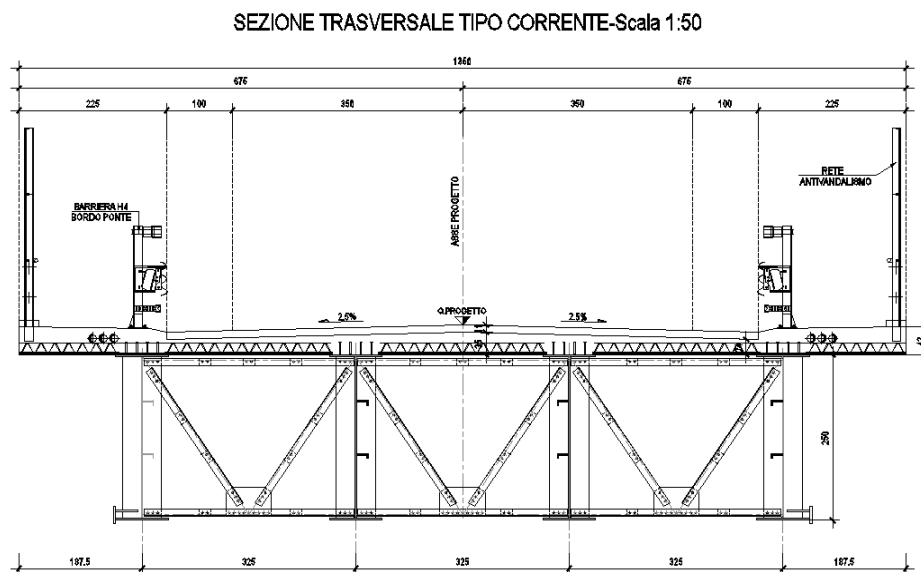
Sezione trasversale tipo dell'impalcato: sezione corrente
